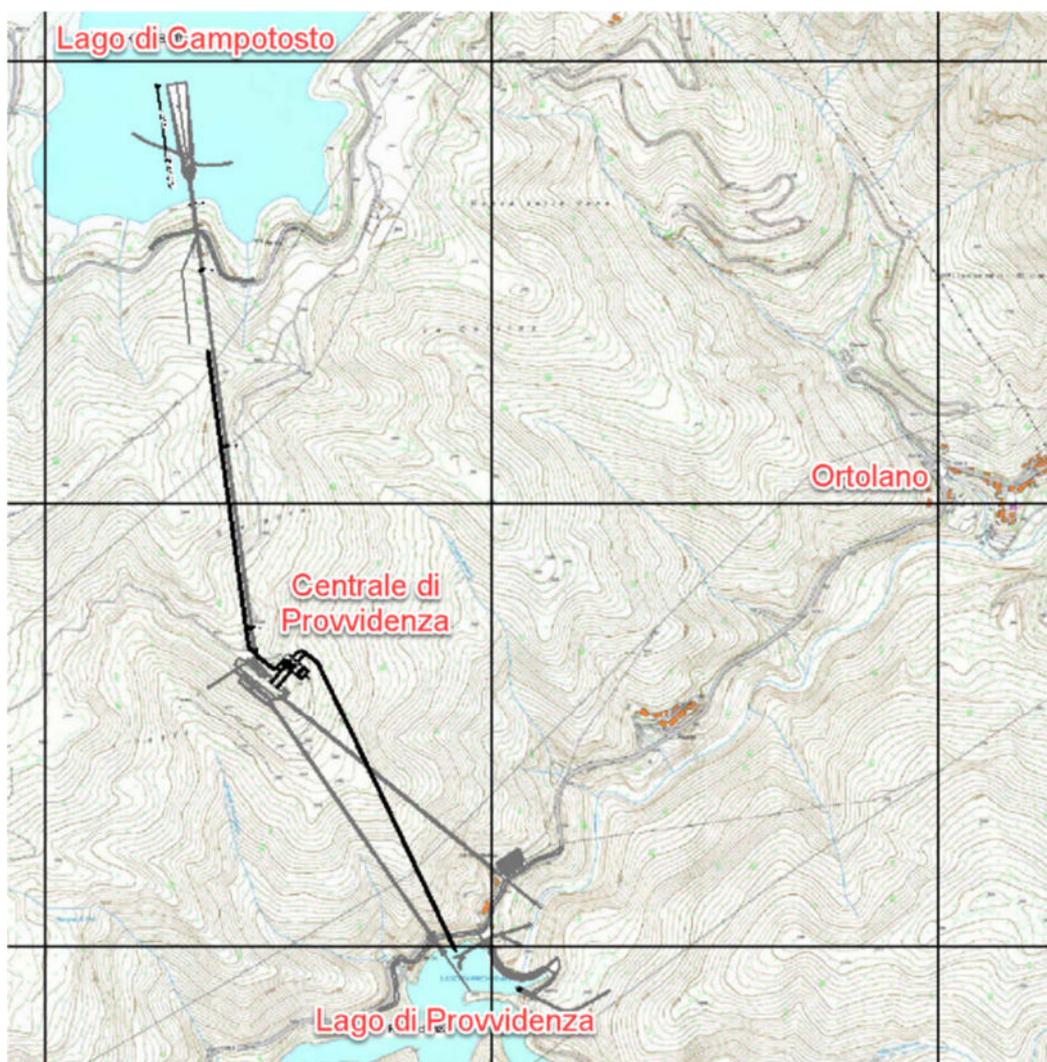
Schema planimetrico dell'impianto di Provvidenza
